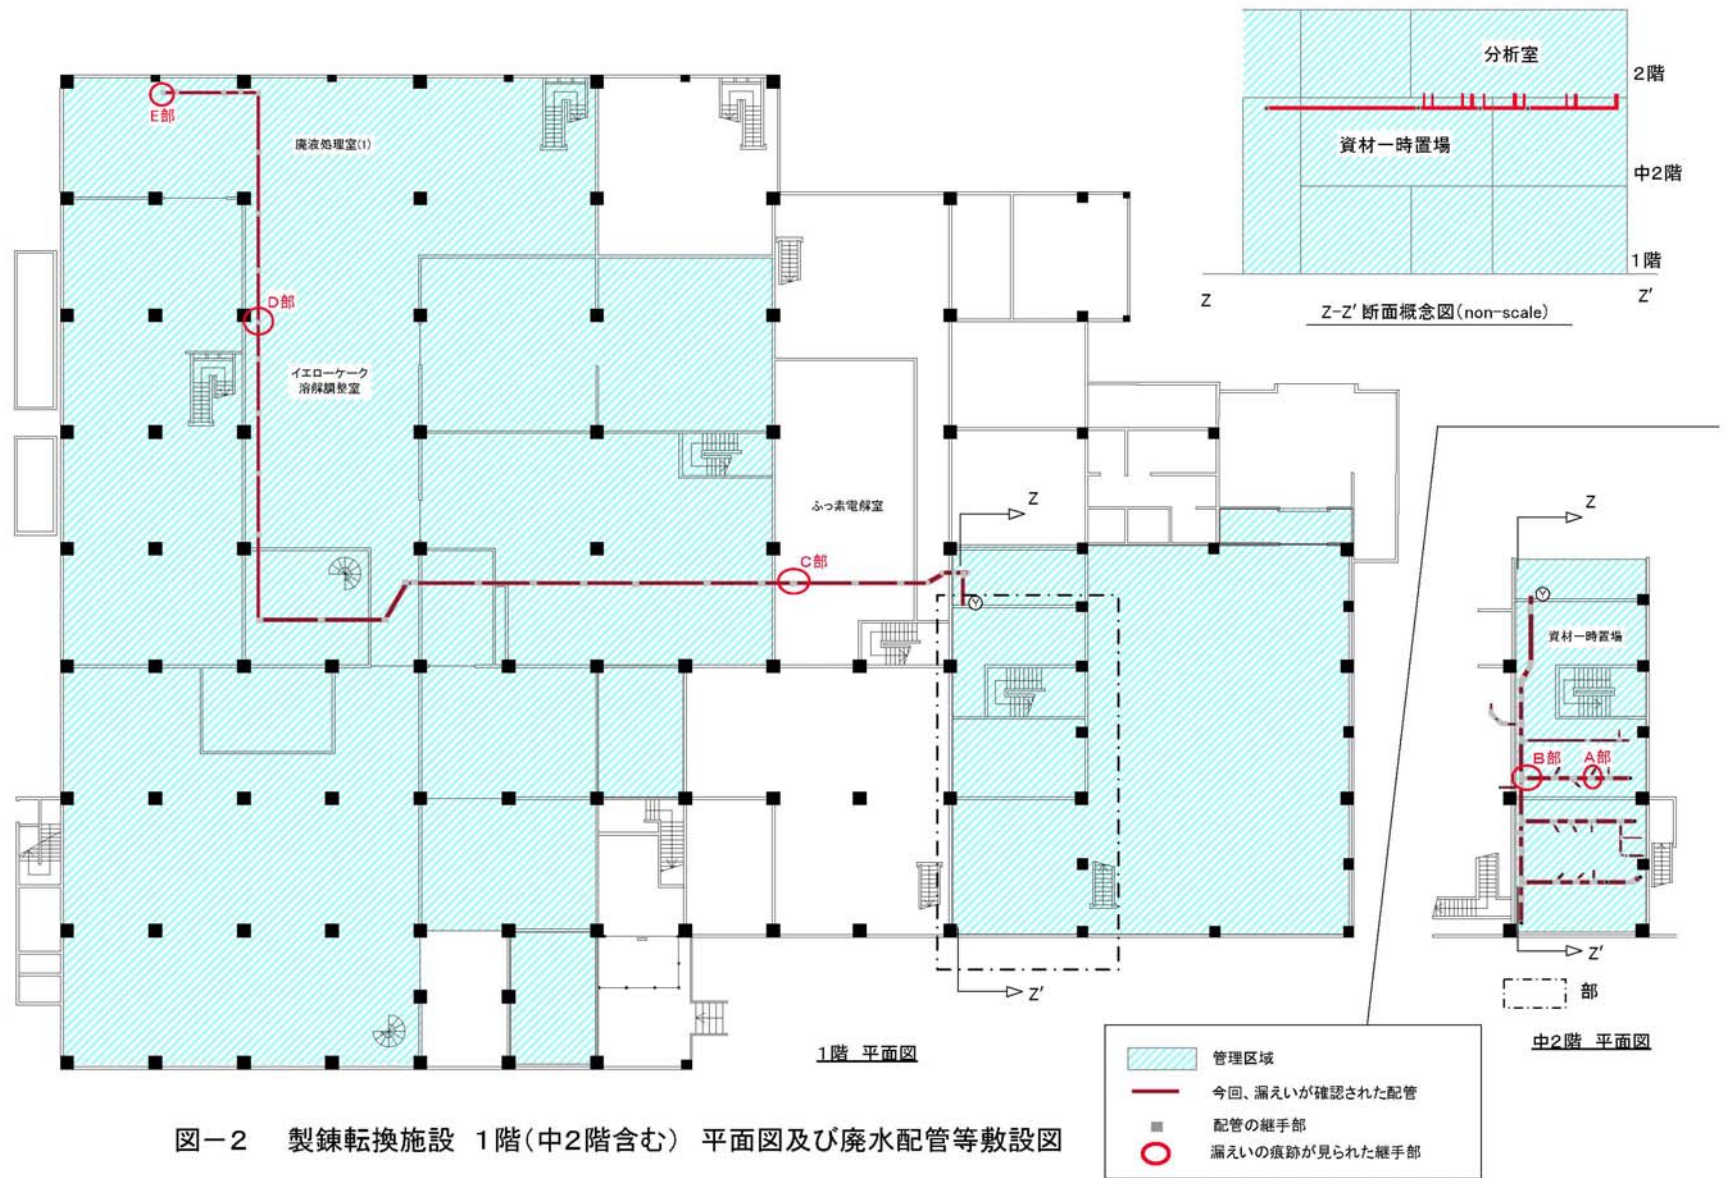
製錬転換施設 1階(中2階含む) 平面図及び廃水配管等敷設図
